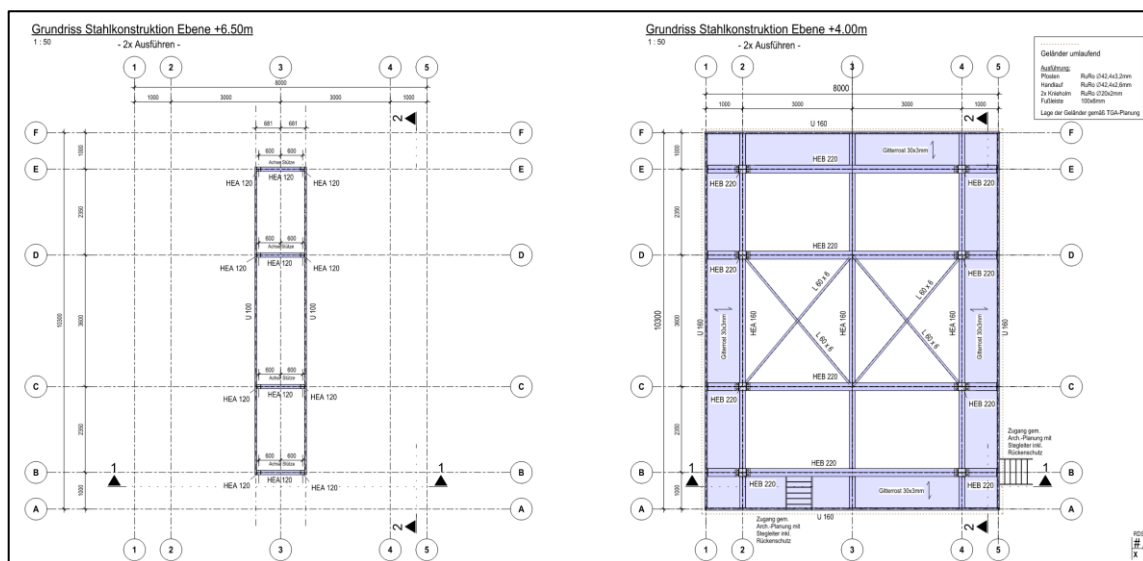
Entwurfszeichnungen der Kühlerpodeste – Grundrisse
